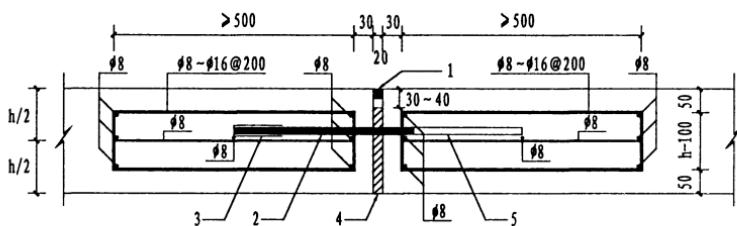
胀缝构造(尺寸单位:mm)
